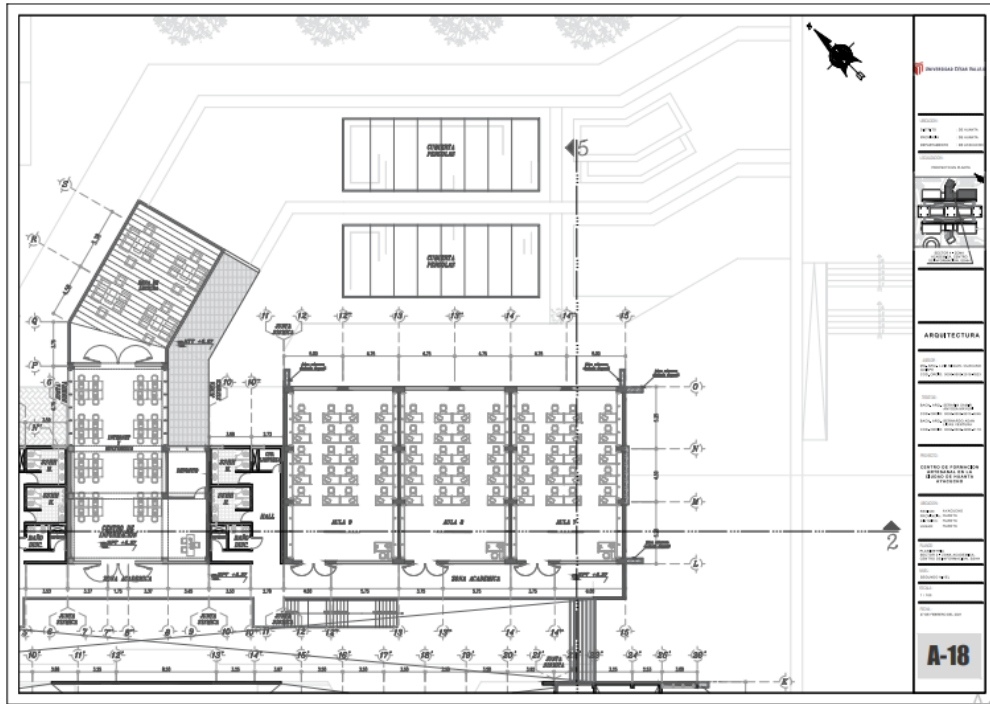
Planimetría del sector 4 ubicado en el piso 2. Escala 1/100.
